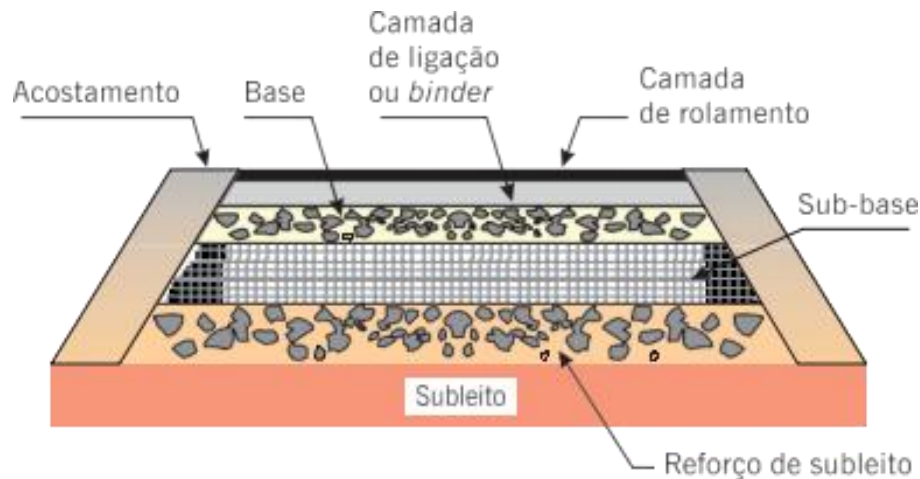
Pavimento flexível visto sob um corte transversal [5].
